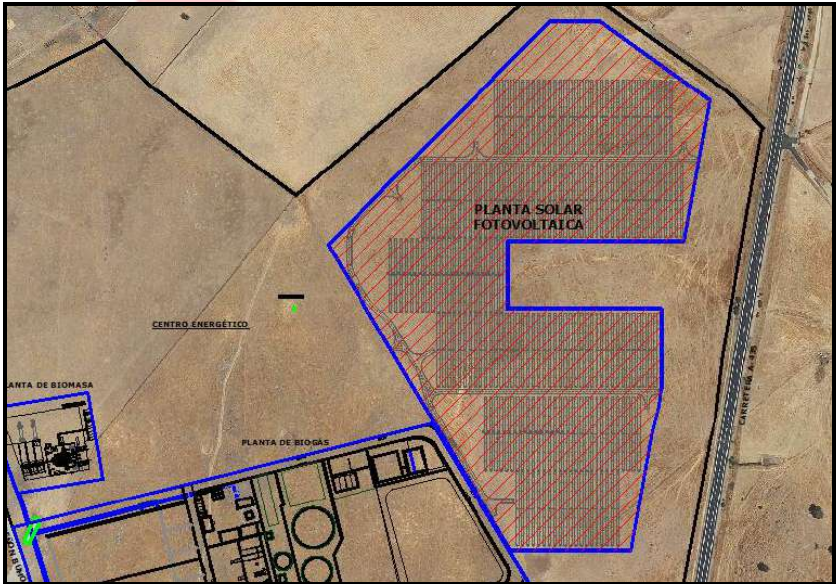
Ubicación de Planta Solar Fotovoltaica en Centro Energético.
